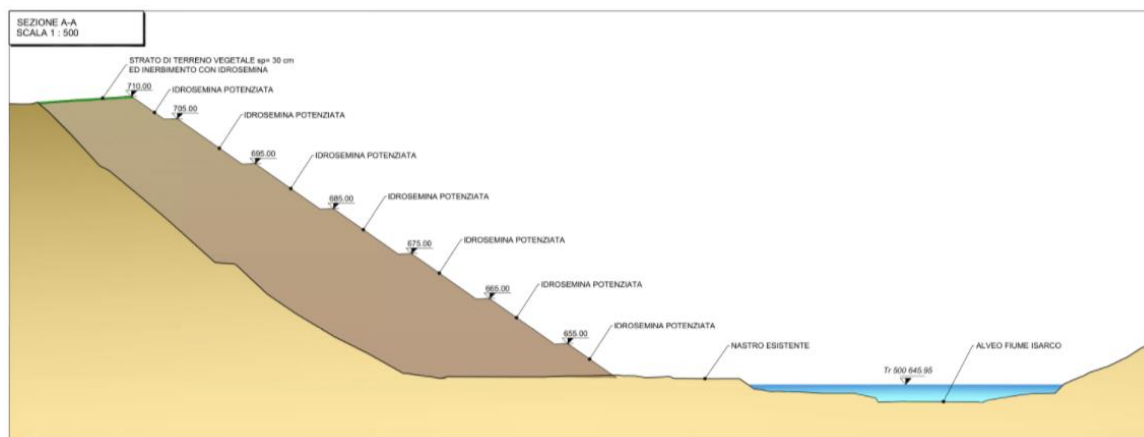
Opere a verde – Sezione di progetto deposito di Plattner.
